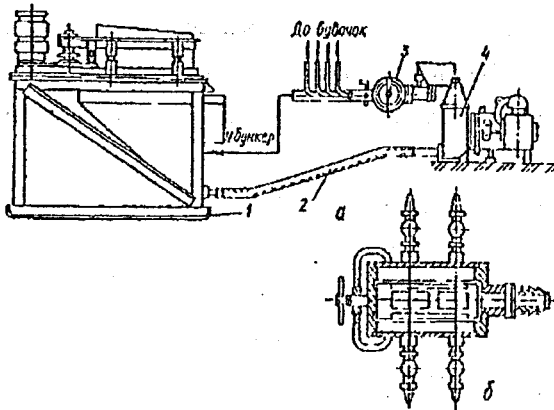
Фарбувальний апарат СО-66А: а - загальний вигляд (1 - бункер; 2 - рукав; 3 - приставка СО-66; 4 - розчинонасос СО-39); б - приставка СО-66
